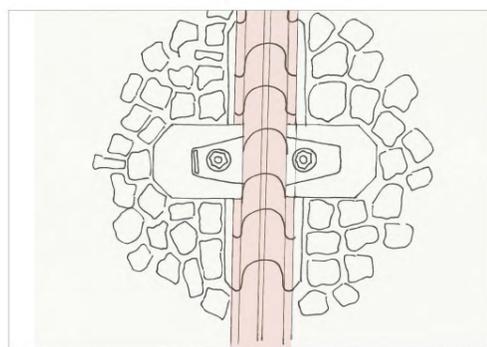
Pormenor do caderno da viagem- Troço Ferroviário
